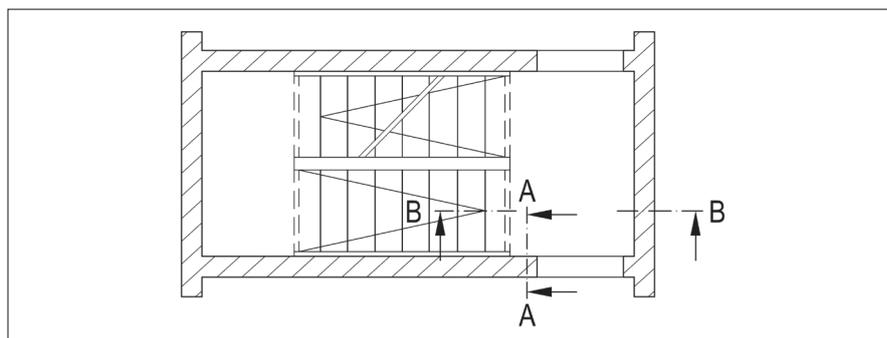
Schwimmender Estrich auf den Podesten bei elastischer Auflagerung der Treppenläufe (Grundriss).
